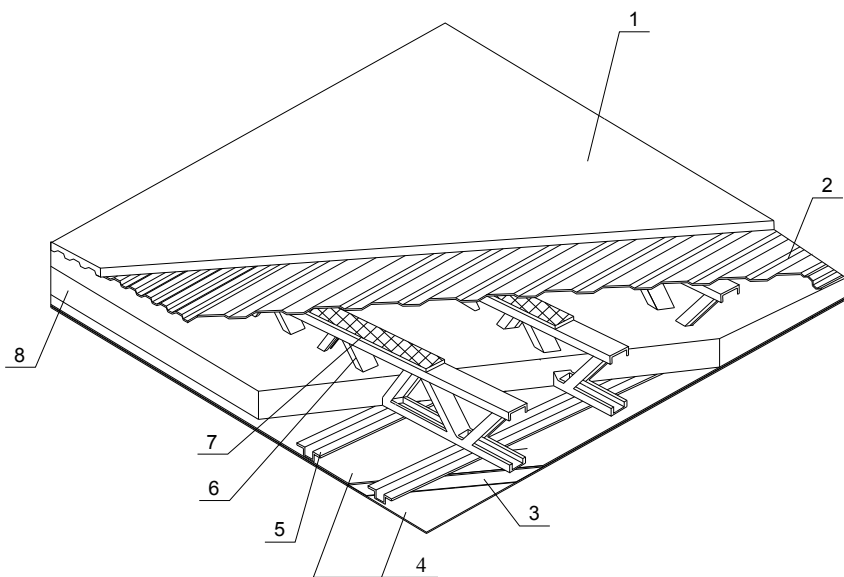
Конструктивное решение междуэтажного перекрытия в зданиях из ЛСТК:
